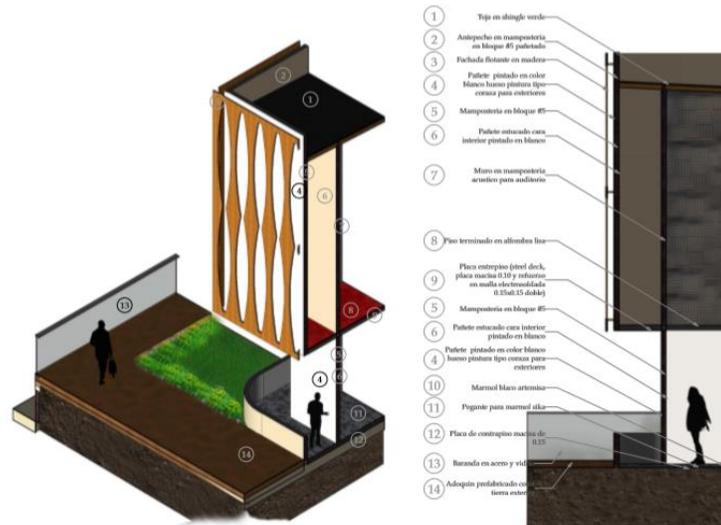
Corte fachada, Equipamiento deportivo y cultural. Elaboración propia
